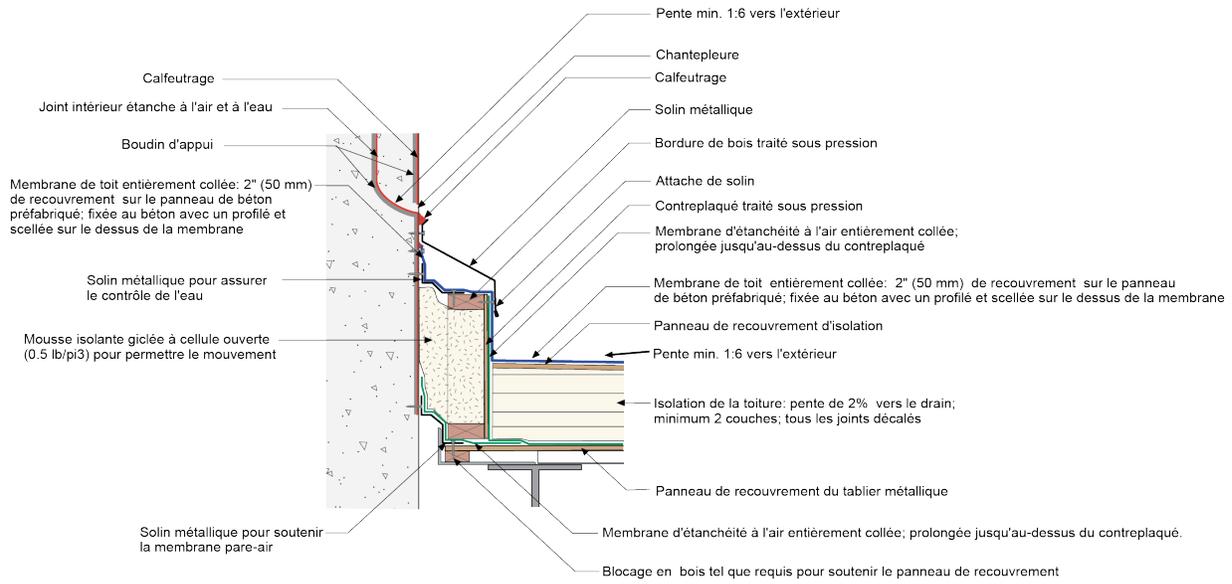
connexion d'un toit à faible pente au mur de béton préfabriqué.
